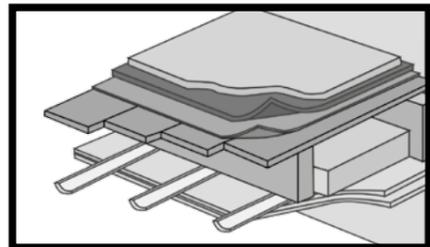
Ce système constructif consiste en un plancher en bois cloué sur des poutres. La pose sur ce système de construction est comparable à la « pose sur bois - Fig. 38 » : suivre les indications reportées.
